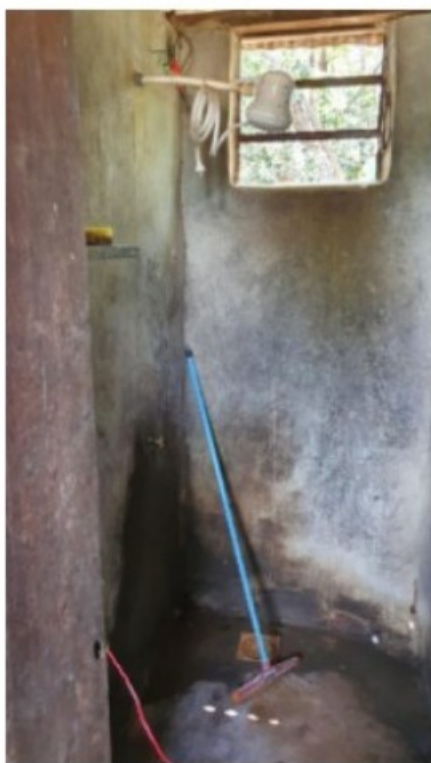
Vaso sanitário. Detalhe para o piso e paredes.
